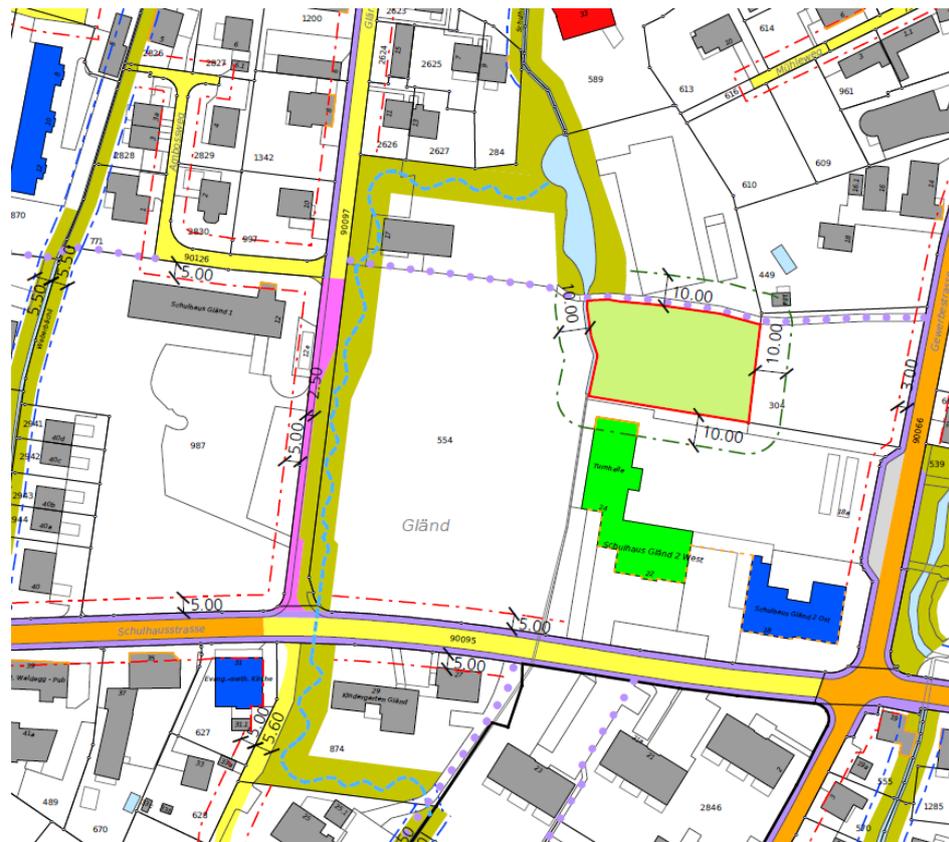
Neue Situation Erschliessungsplan und Strassenklassierung
